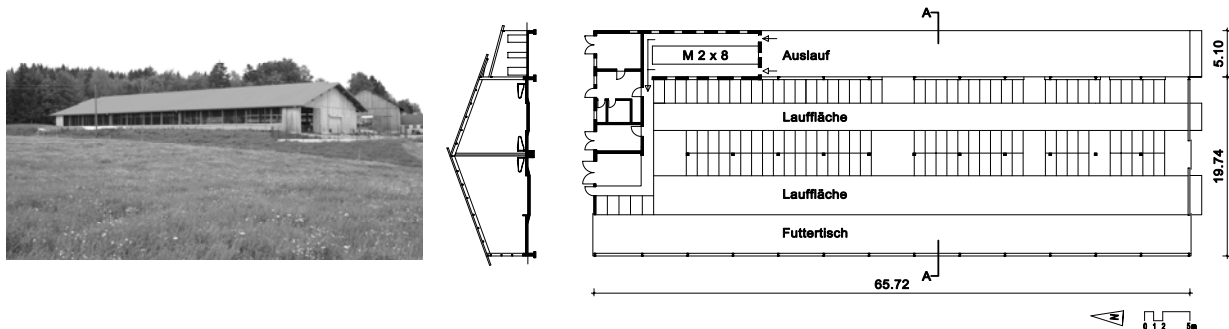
Ansicht, Grundriss – Schnitt
